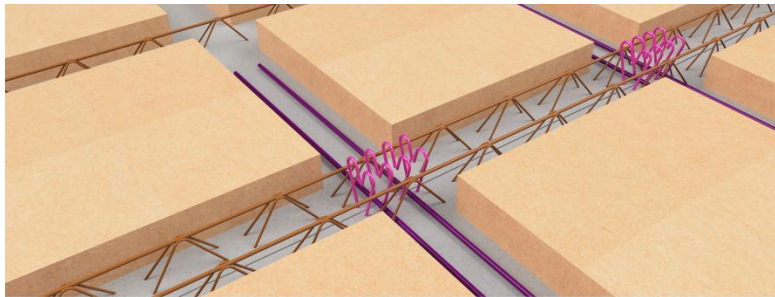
armatures sur joint - configuration joint avec paniers couture
